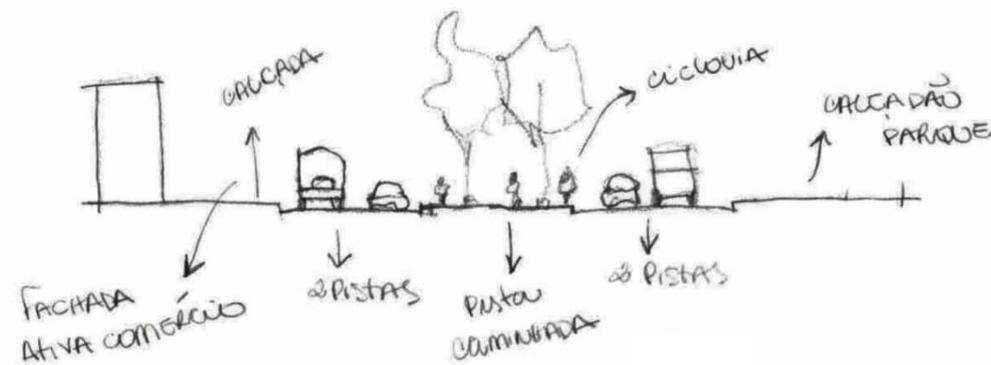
Croqui perfil viário do boulevard. Fonte: Autora, 2020.
